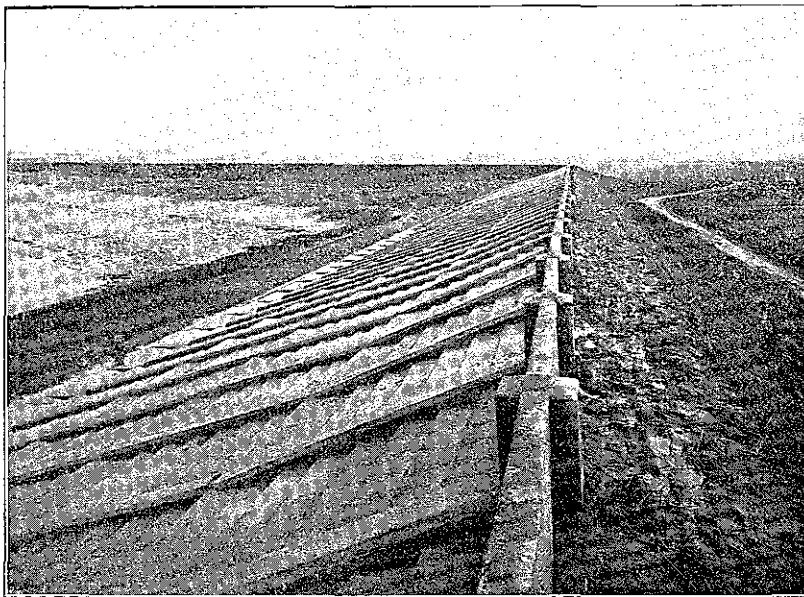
Betondijksverhooging met aansluitende betonglooiing volgens systeem de M. aan den calamiteuzen Vlietepolder
